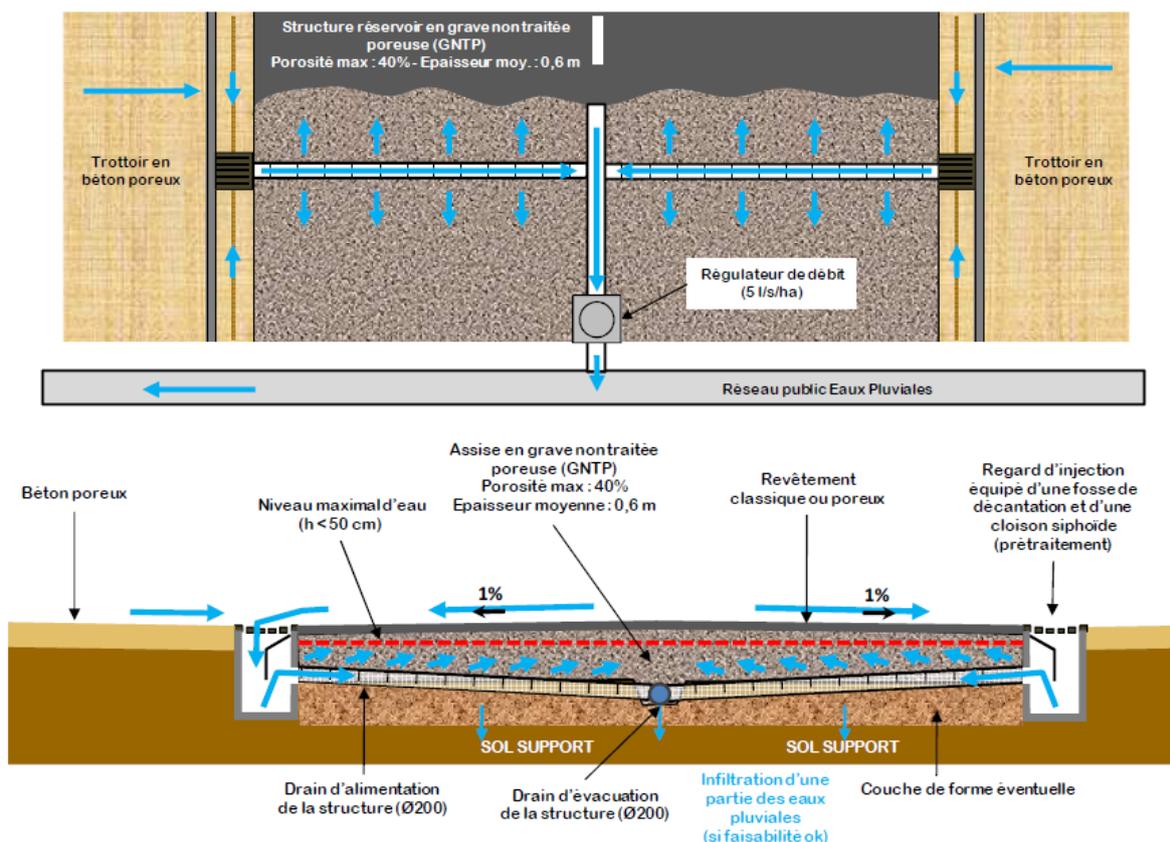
Vue de dessus et en coupe d'une chaussée à structure réservoir (Source : DSEA)
